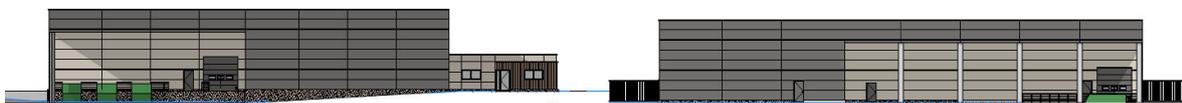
VUE SUR FAÇADES NORD (A GAUCHE) ET EST (A DROITE).
